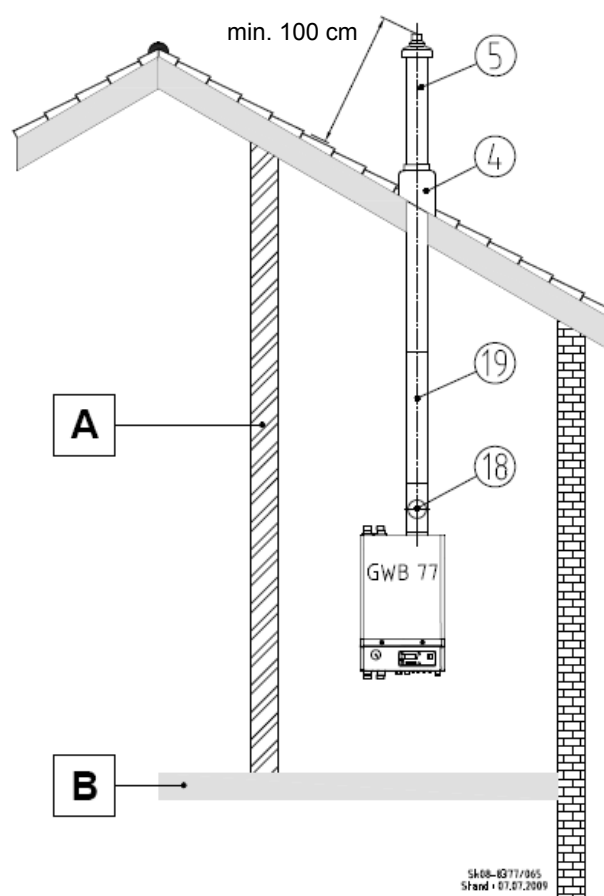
Centrala dachowa z przejściem przez strop i dach.
